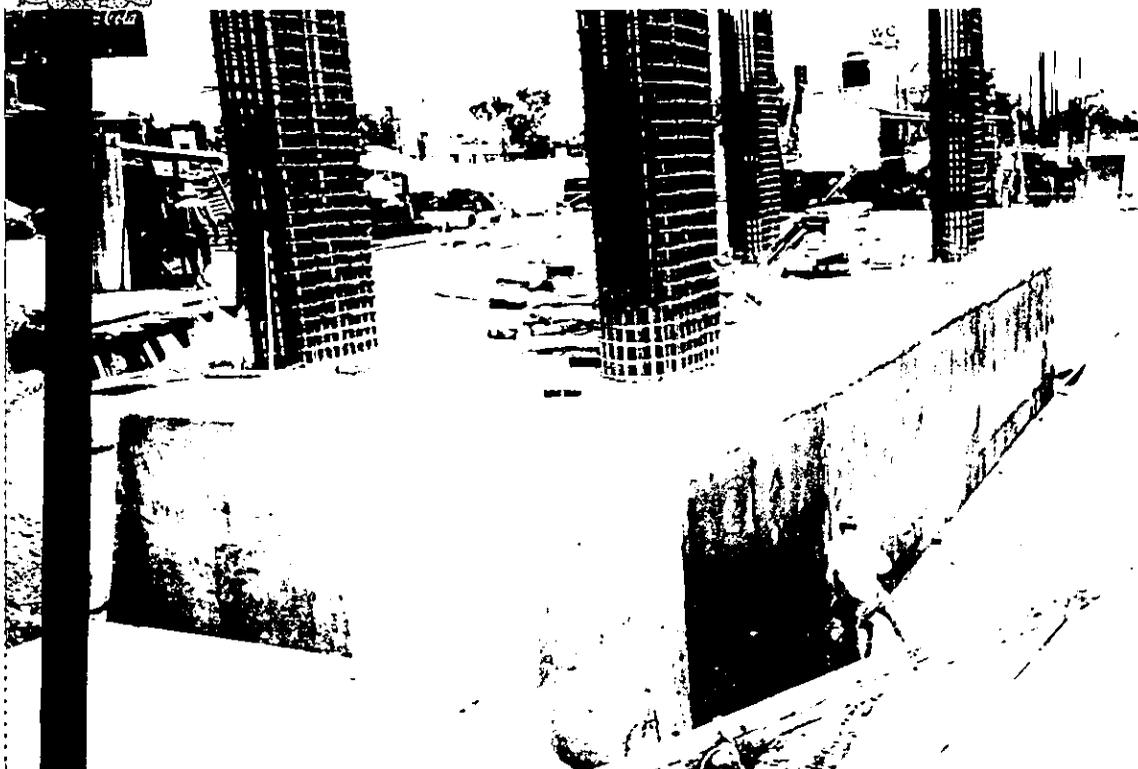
Cajón de cimentación concluido hasta el desplante de las columnas coladas en sitio de sección oblonga
